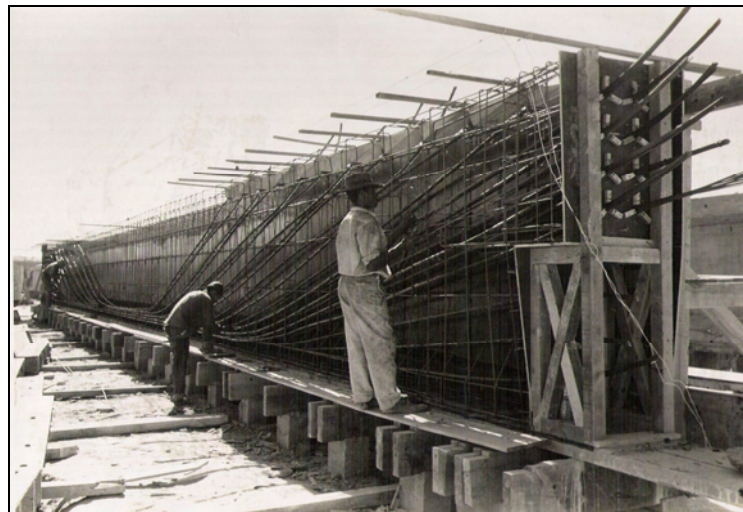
Longarinas sendo armadas no canteiro de obra podendo ser visto a disposição das armaduras e cabos de protensão (Arquivo Público, data e autor não identificados).
